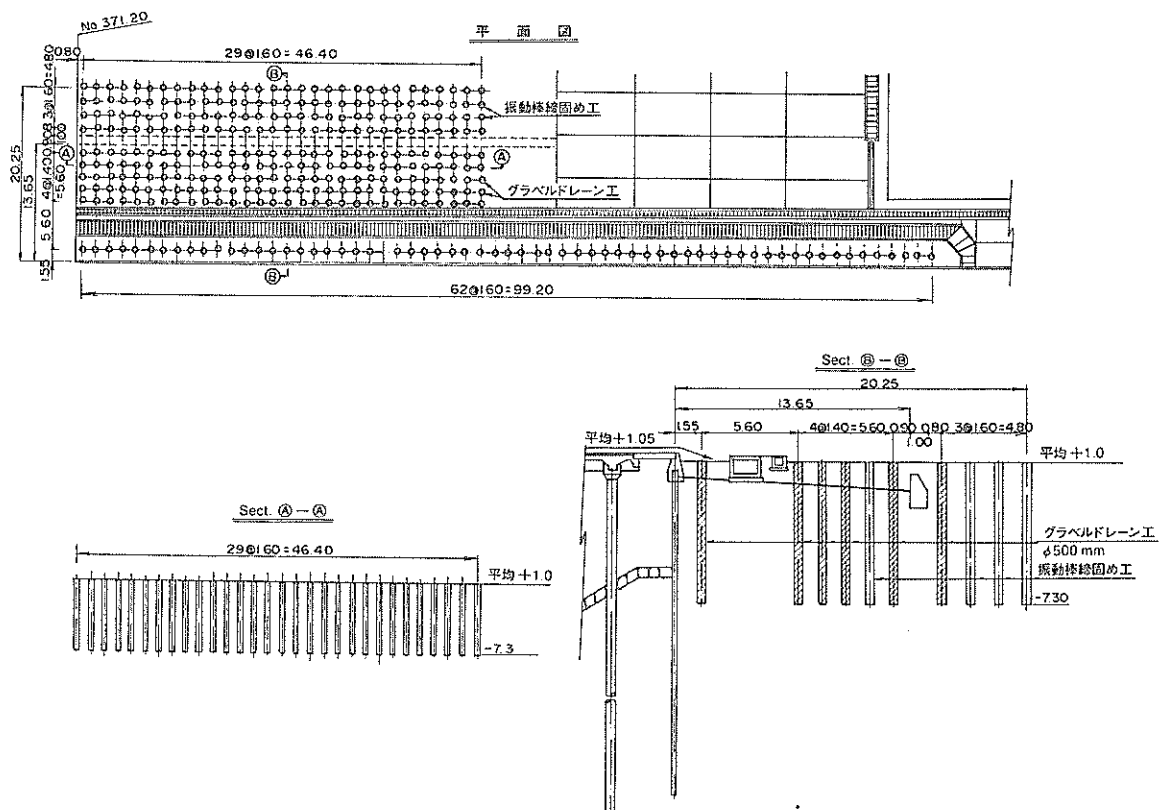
外港昭和北1号岸壁⑮ 地盤改良工配置図 (抜粋)
